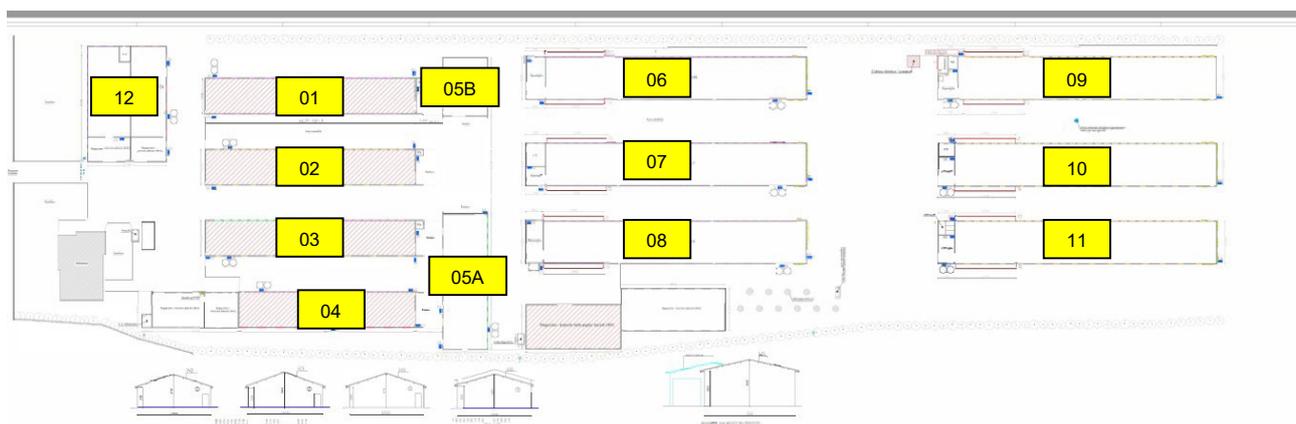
Planimetria con disposizione e numerazione dei ricoveri esistenti.
